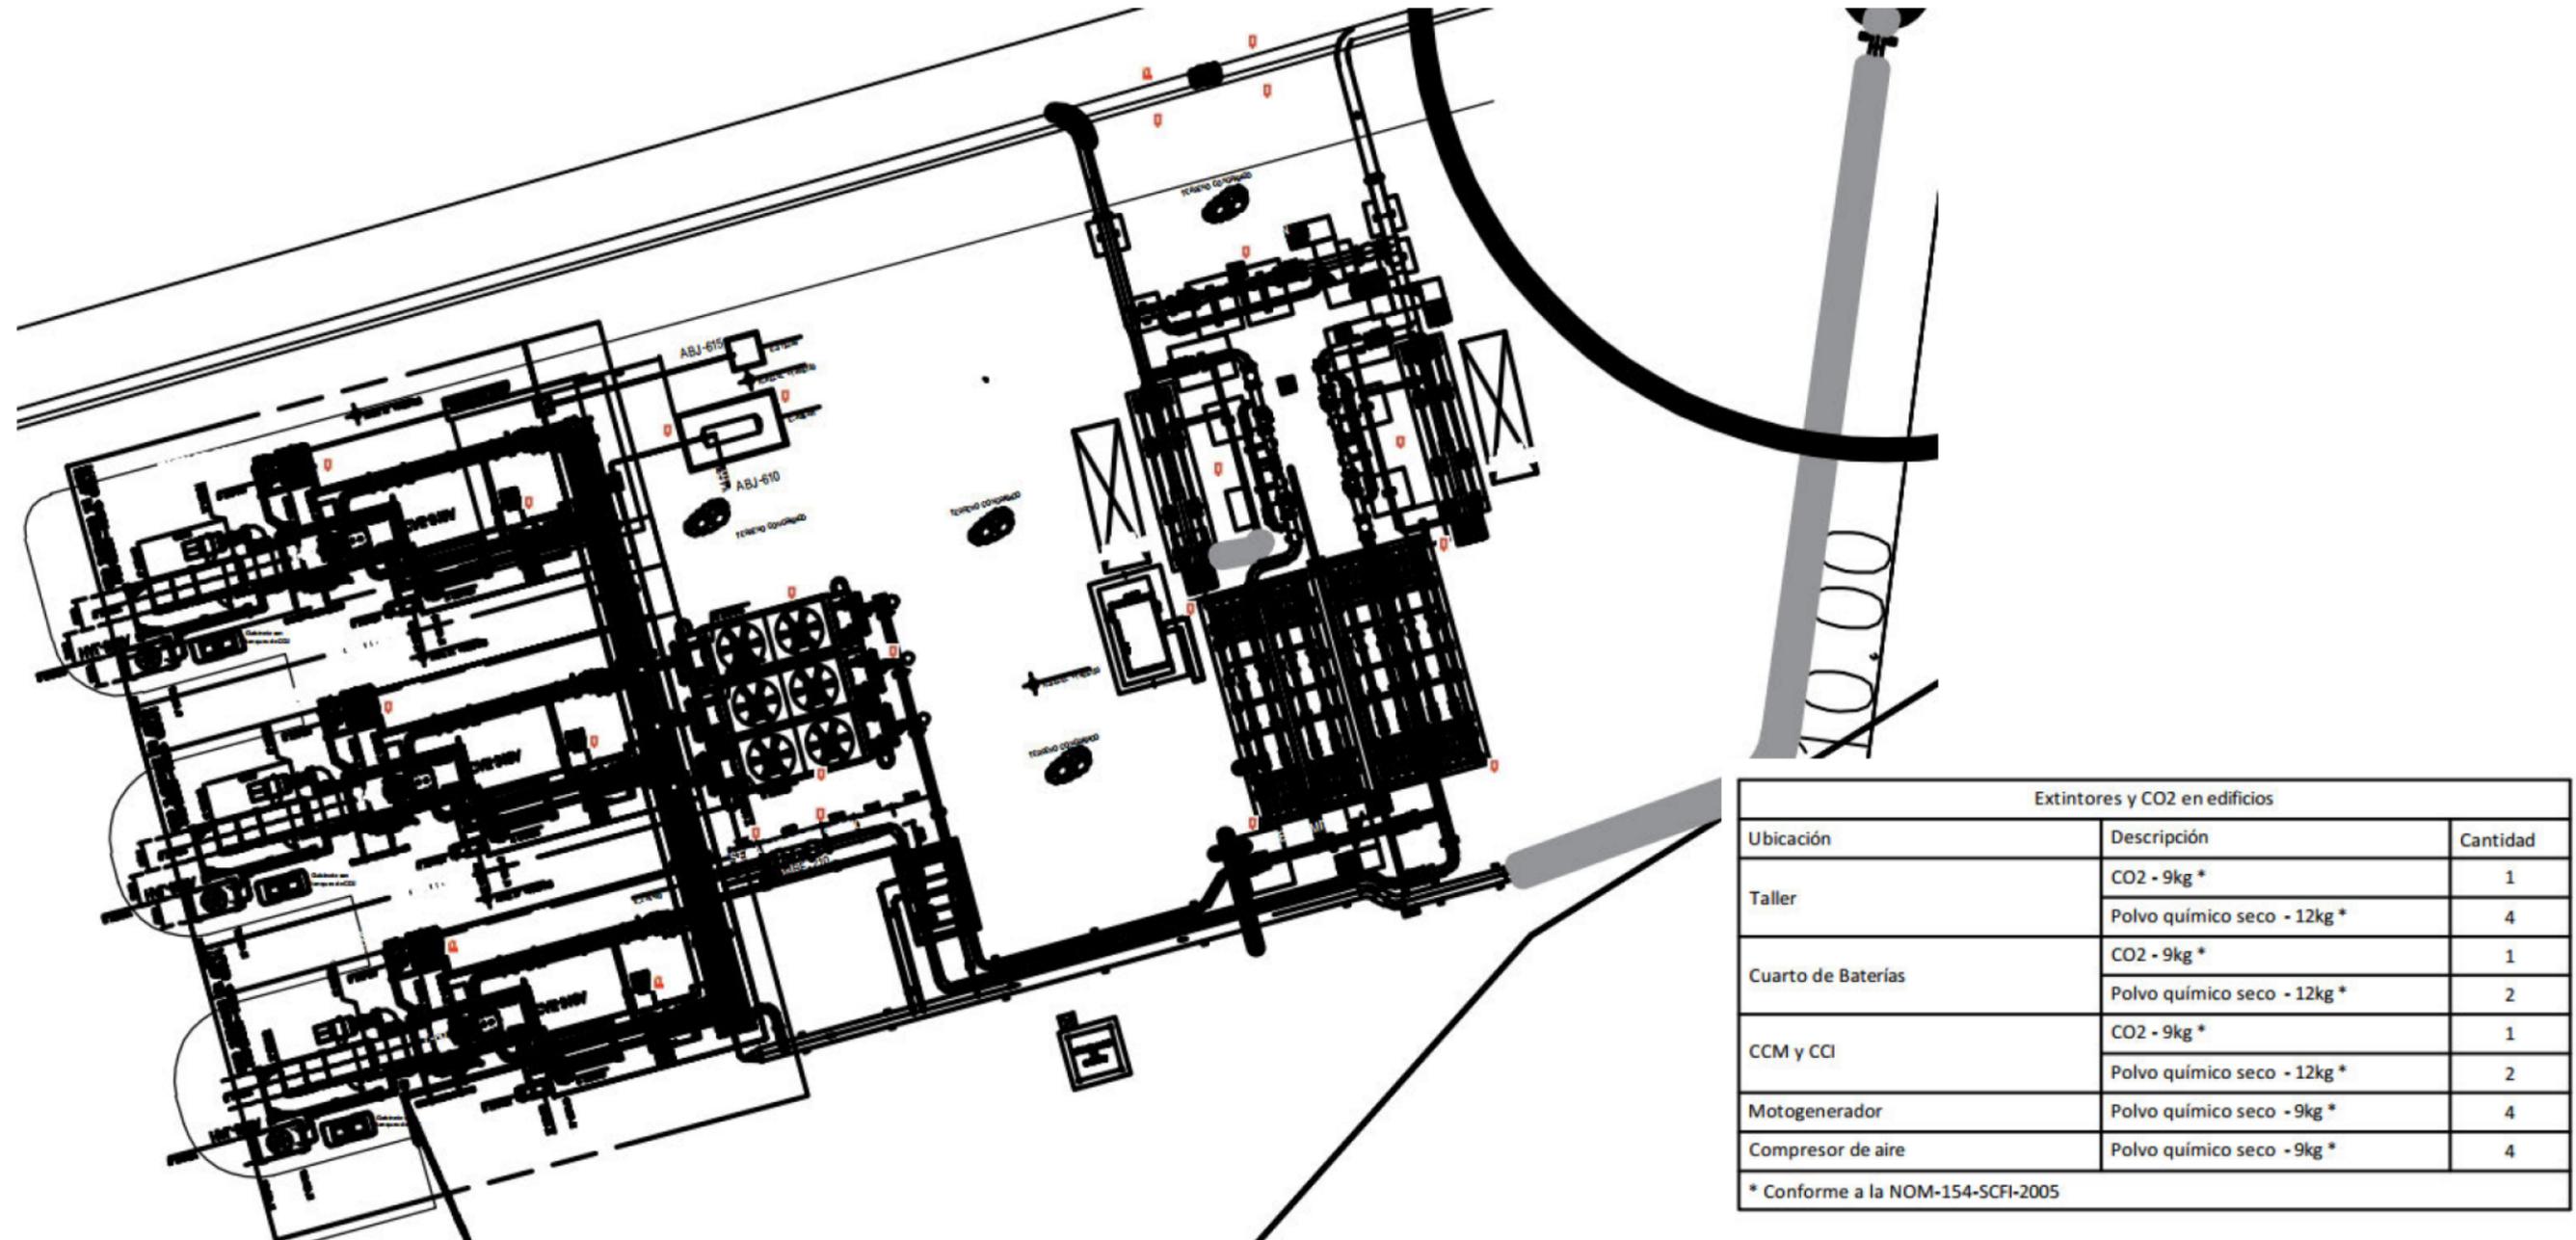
PLANO DE LOCALIZACIÓN GENERAL DE EXTINTORES
